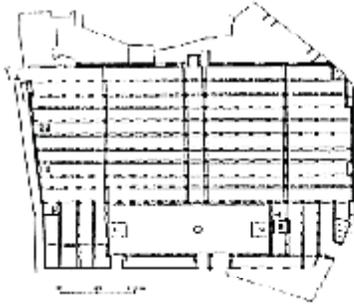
مسقط أفقي لجامع تيمماتل الموحدي
